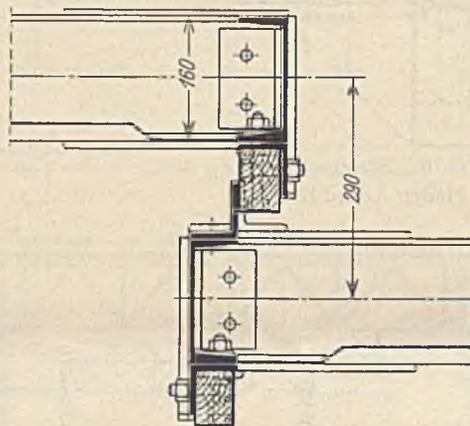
Flugzeughalle B. Mitnehmerkonstruktion an den Toren.
